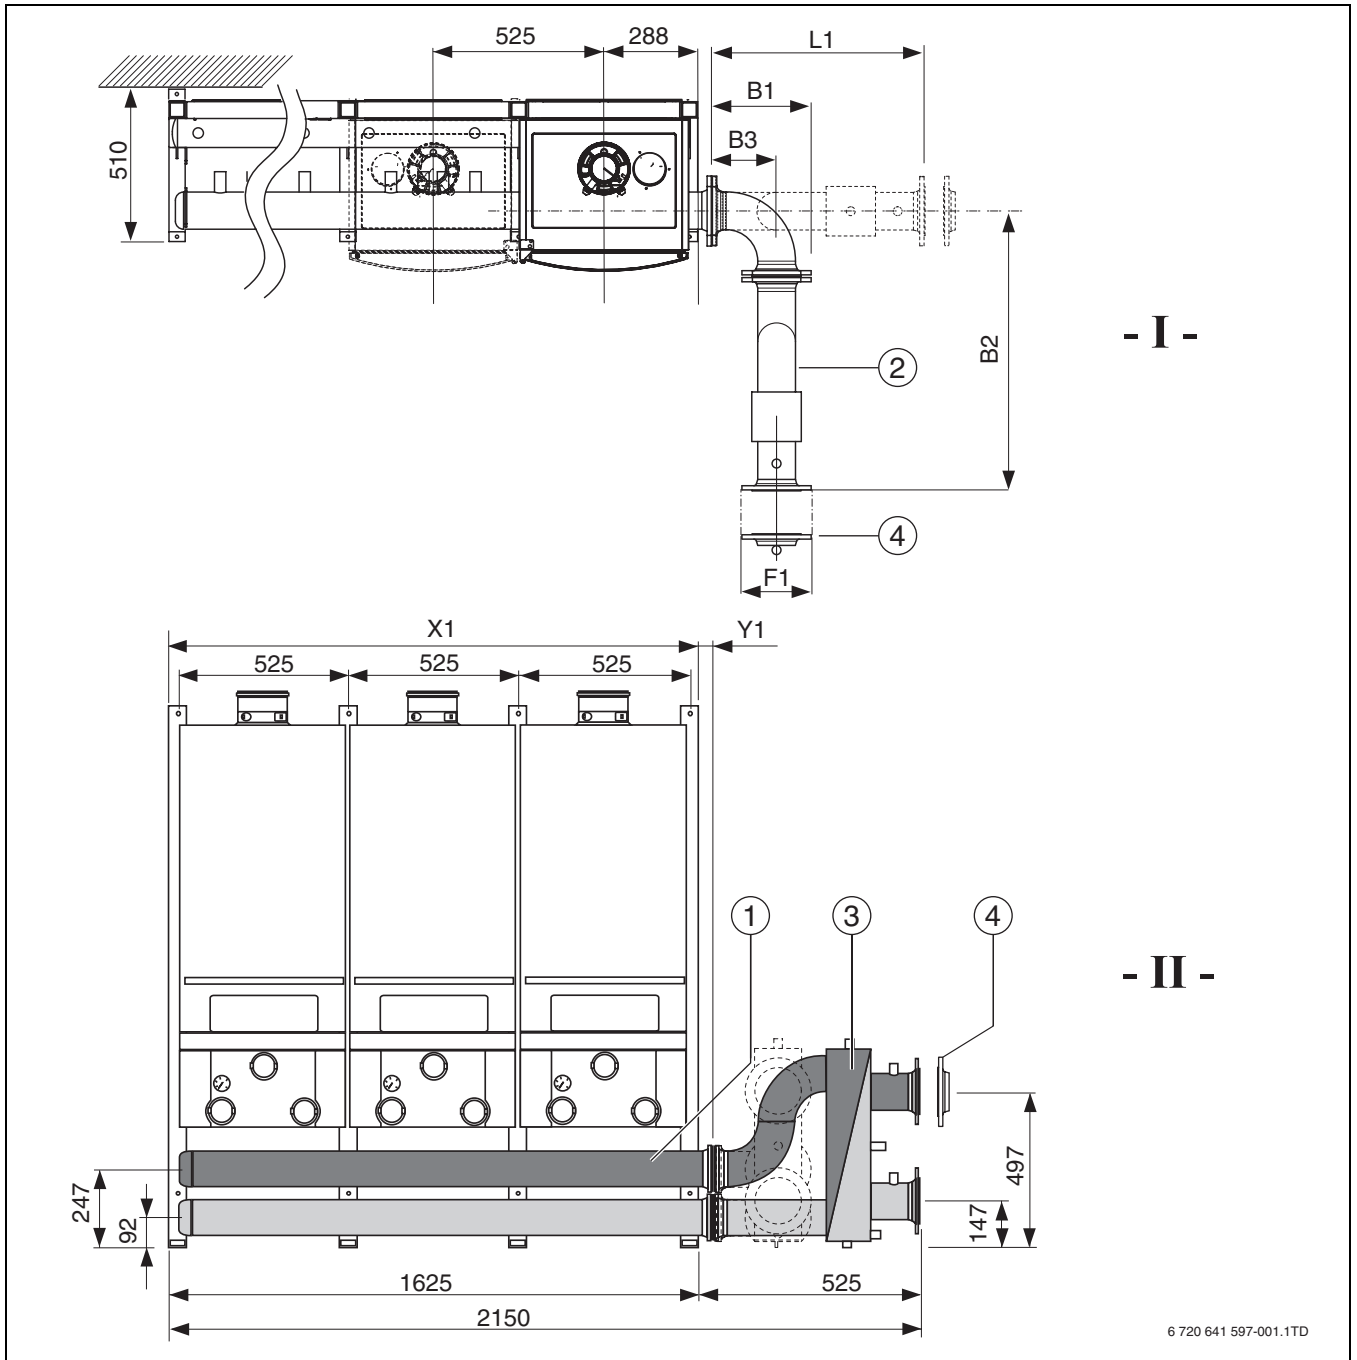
Dimensiune sistem în cascadă TL asamblare liniară [mm]
